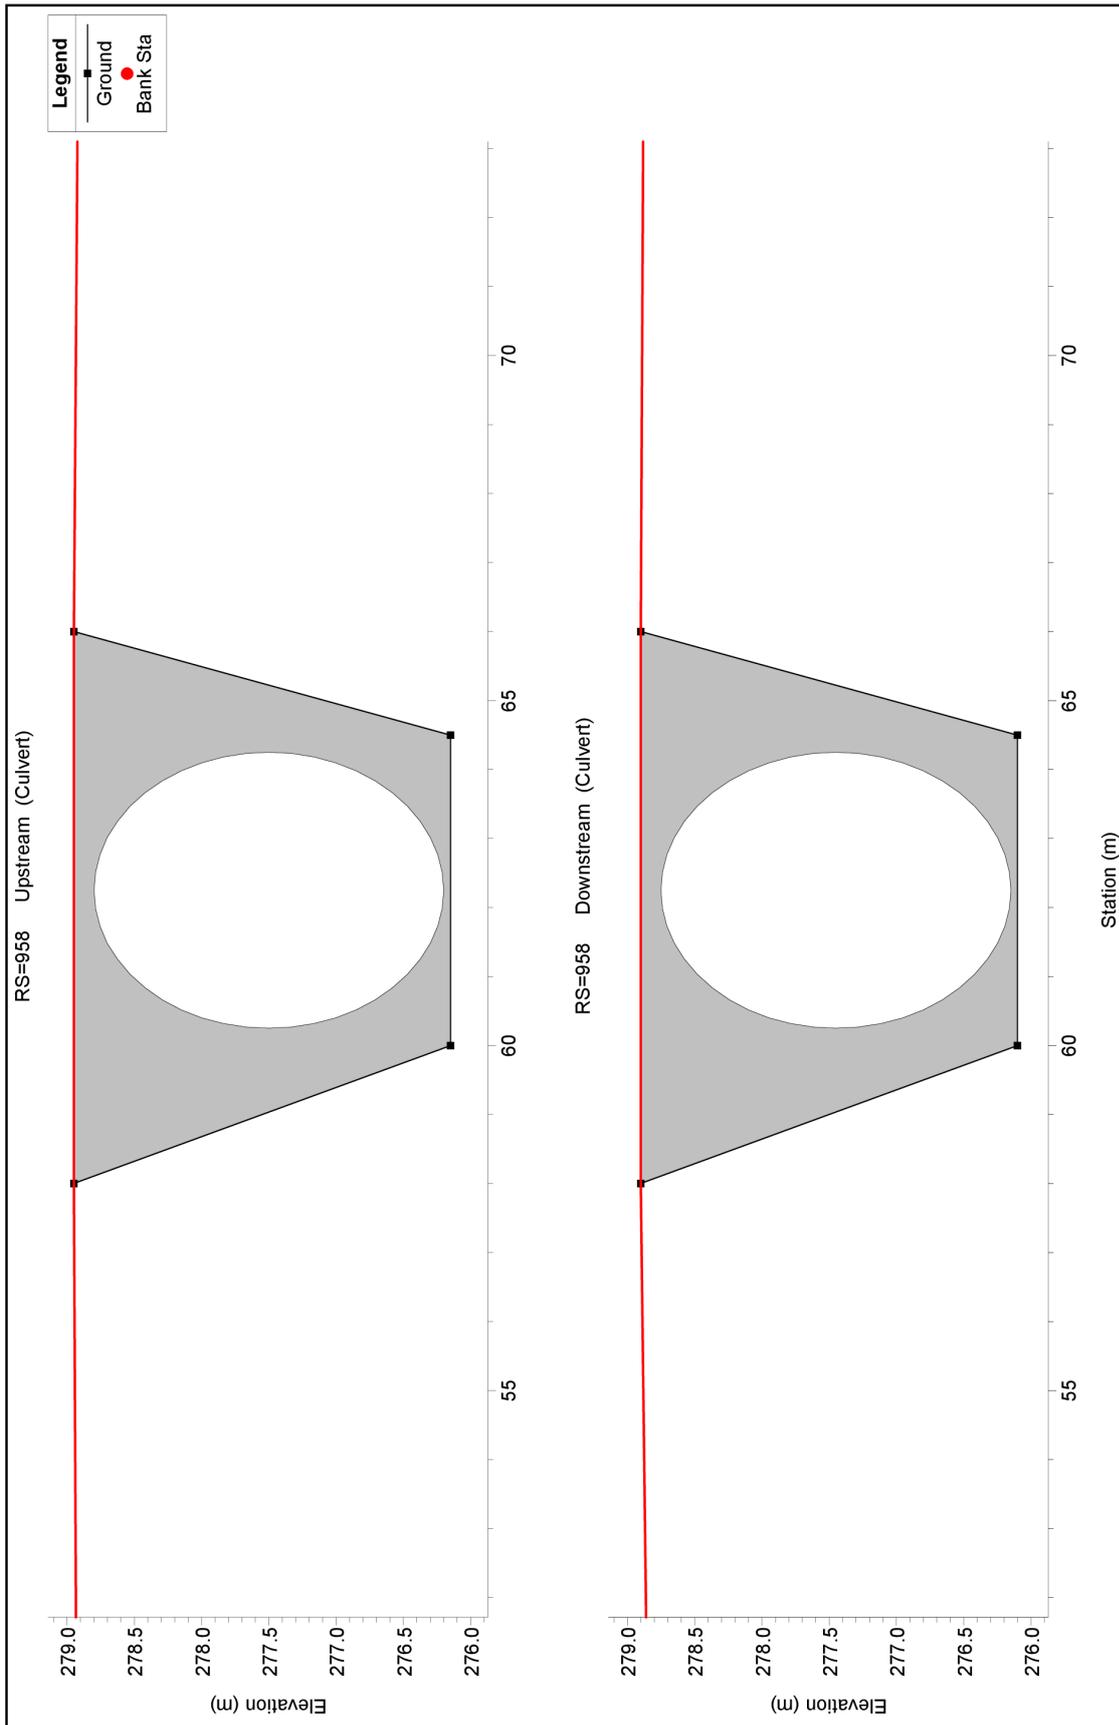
Modellazione in HEC-RAS Canale tombato a sezione circolare (RS = 958)
